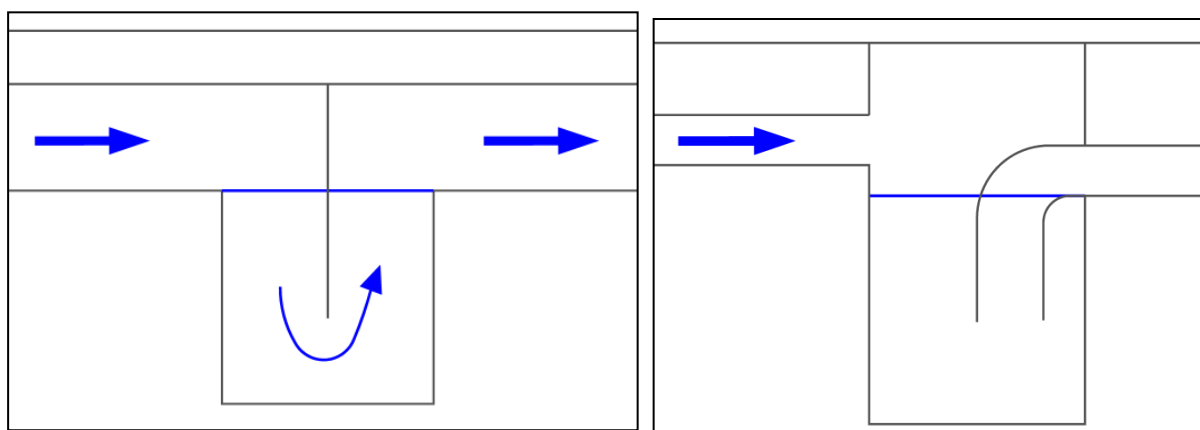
Schémas de principe de 2 exemples de zones de décantation (cloison siphonée et coude PVC)
